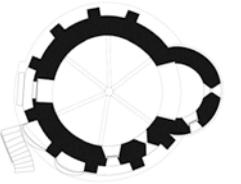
Grundriss Wildpaner 2009. M 1:400.
